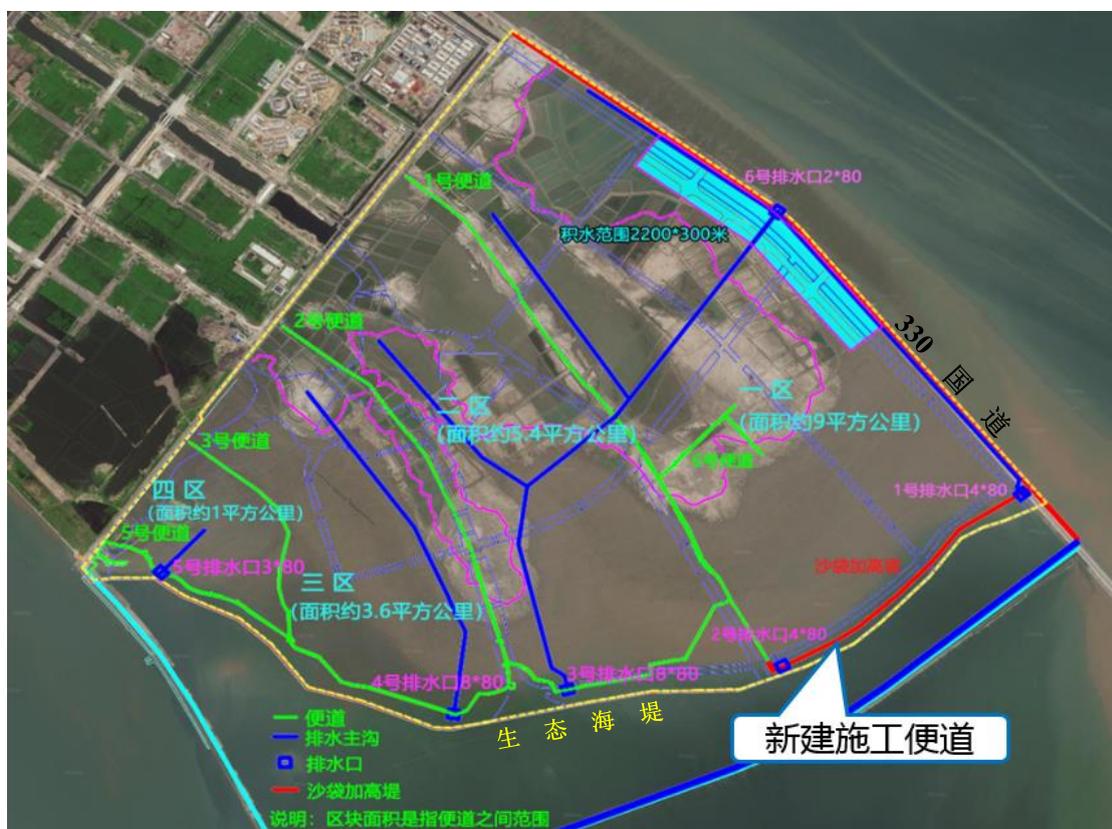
浅滩二期围区施工便道分布示意图（新建施工便道方案，推荐）
